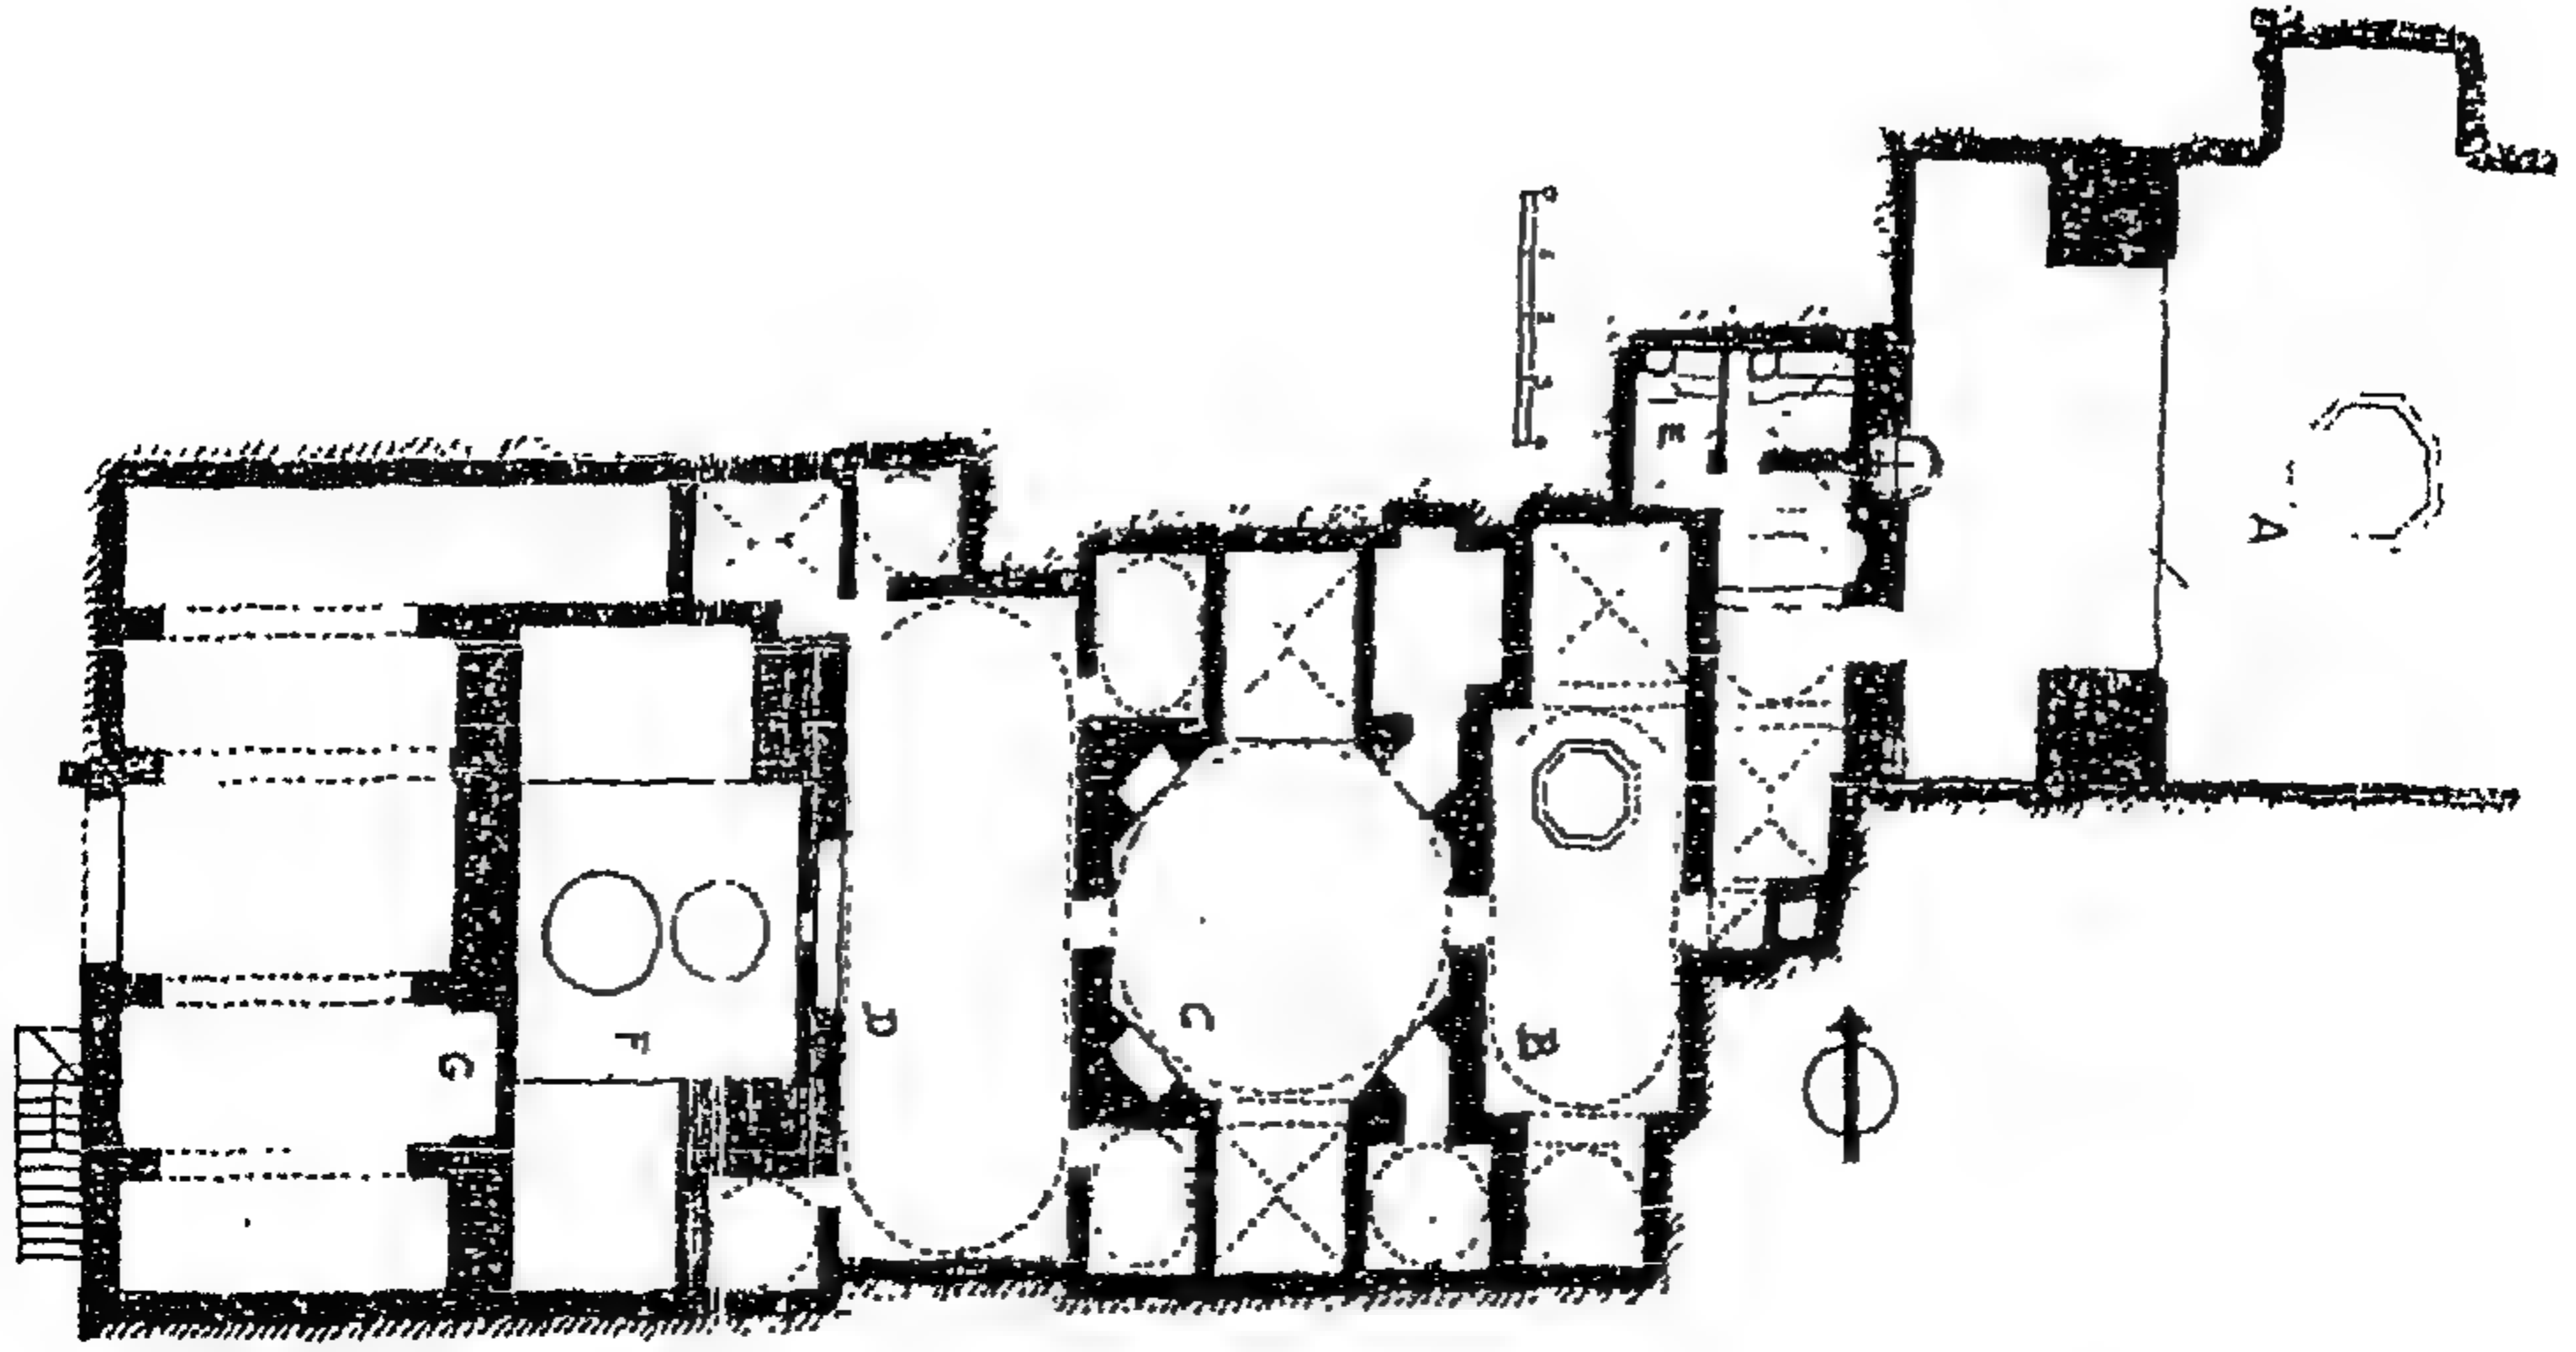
مسقط أفقي لقصر المشتي. (عن : كريزول).
